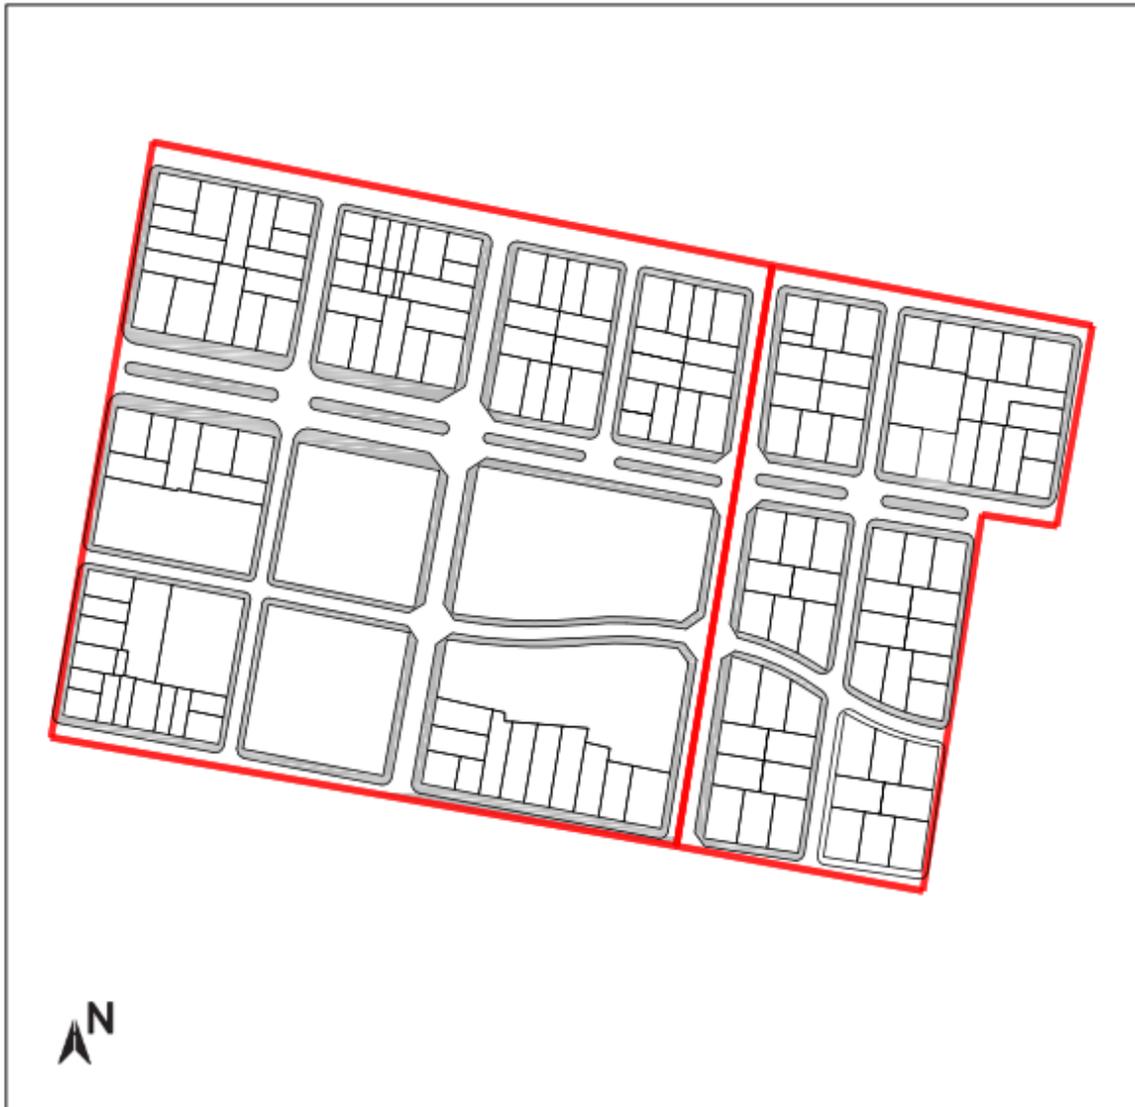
Caja de Vivienda Popular (1944). Plano de Loteo del Barrio Santa Fe. Escala 1:100. Fuente: Planoteca de la Secretaria distrital de Planeación.
